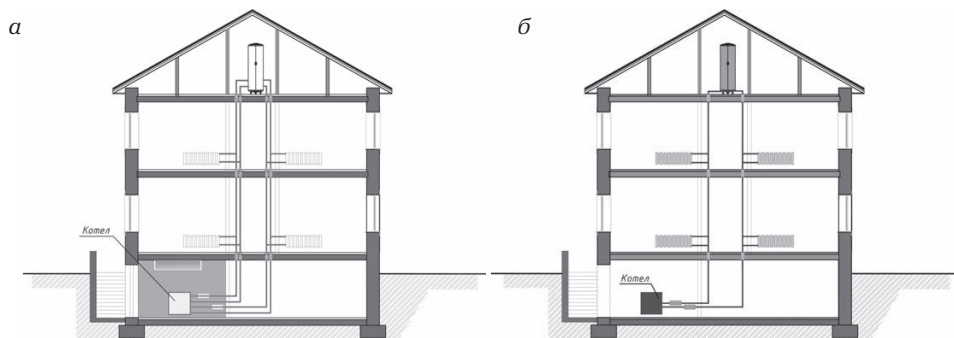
Размещение котельной: а — в подвале или на цокольном этаже; б — на первом этаже
